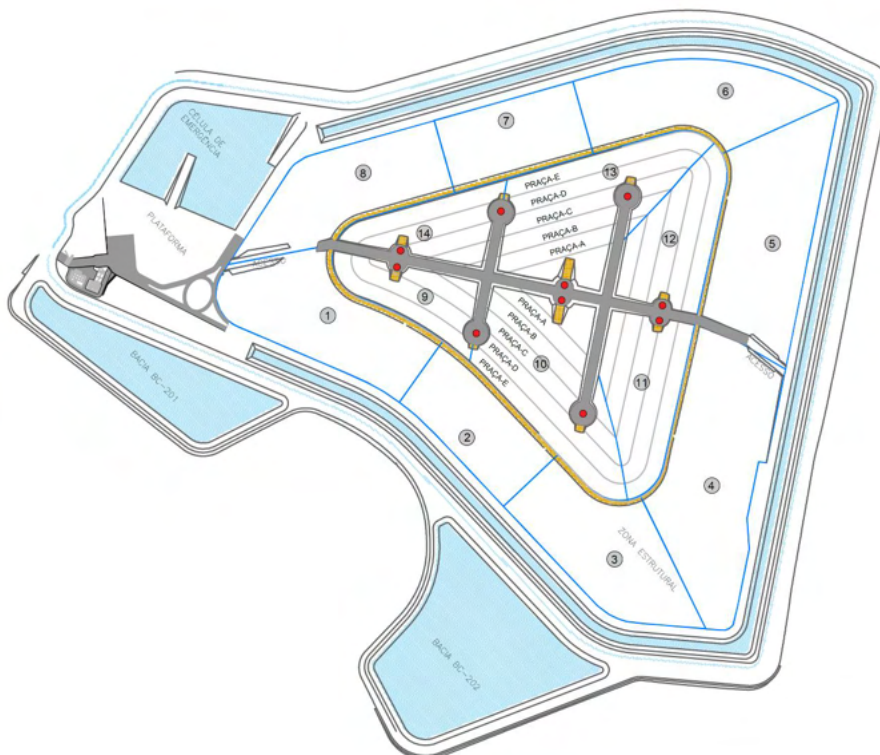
Setorização da Zona Interna em faixas e praças (Fonte: OM-3541-54-G-282 R08)
